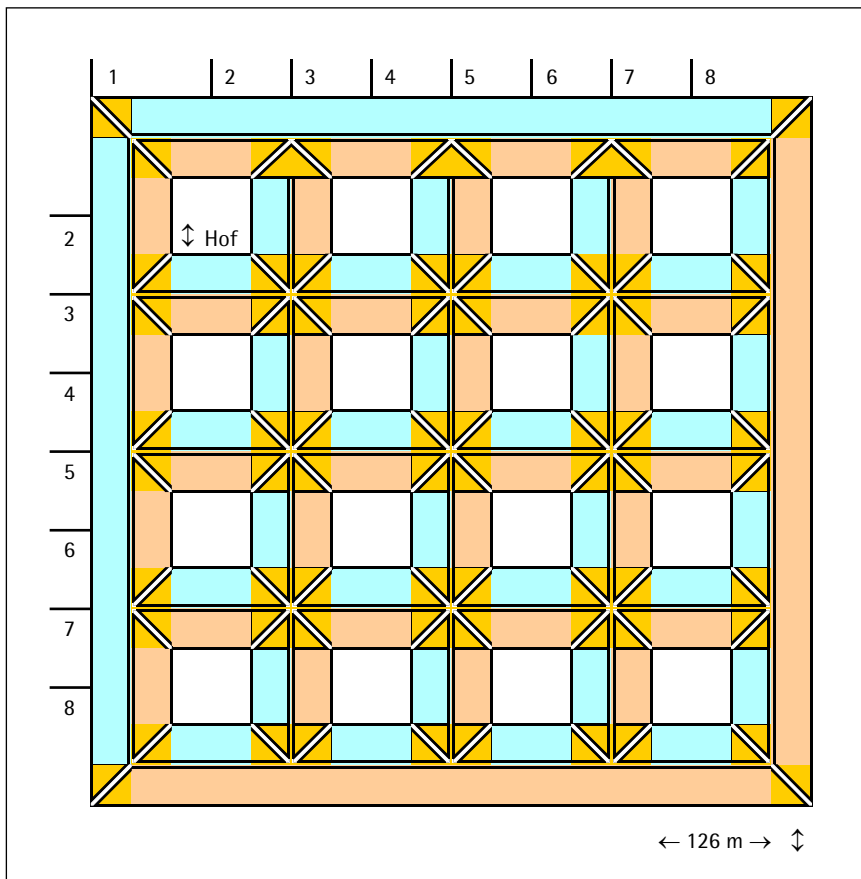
Nutzbare Dachfläche bei geschlossener -, Block- und Innenraum - nach Bebauung
